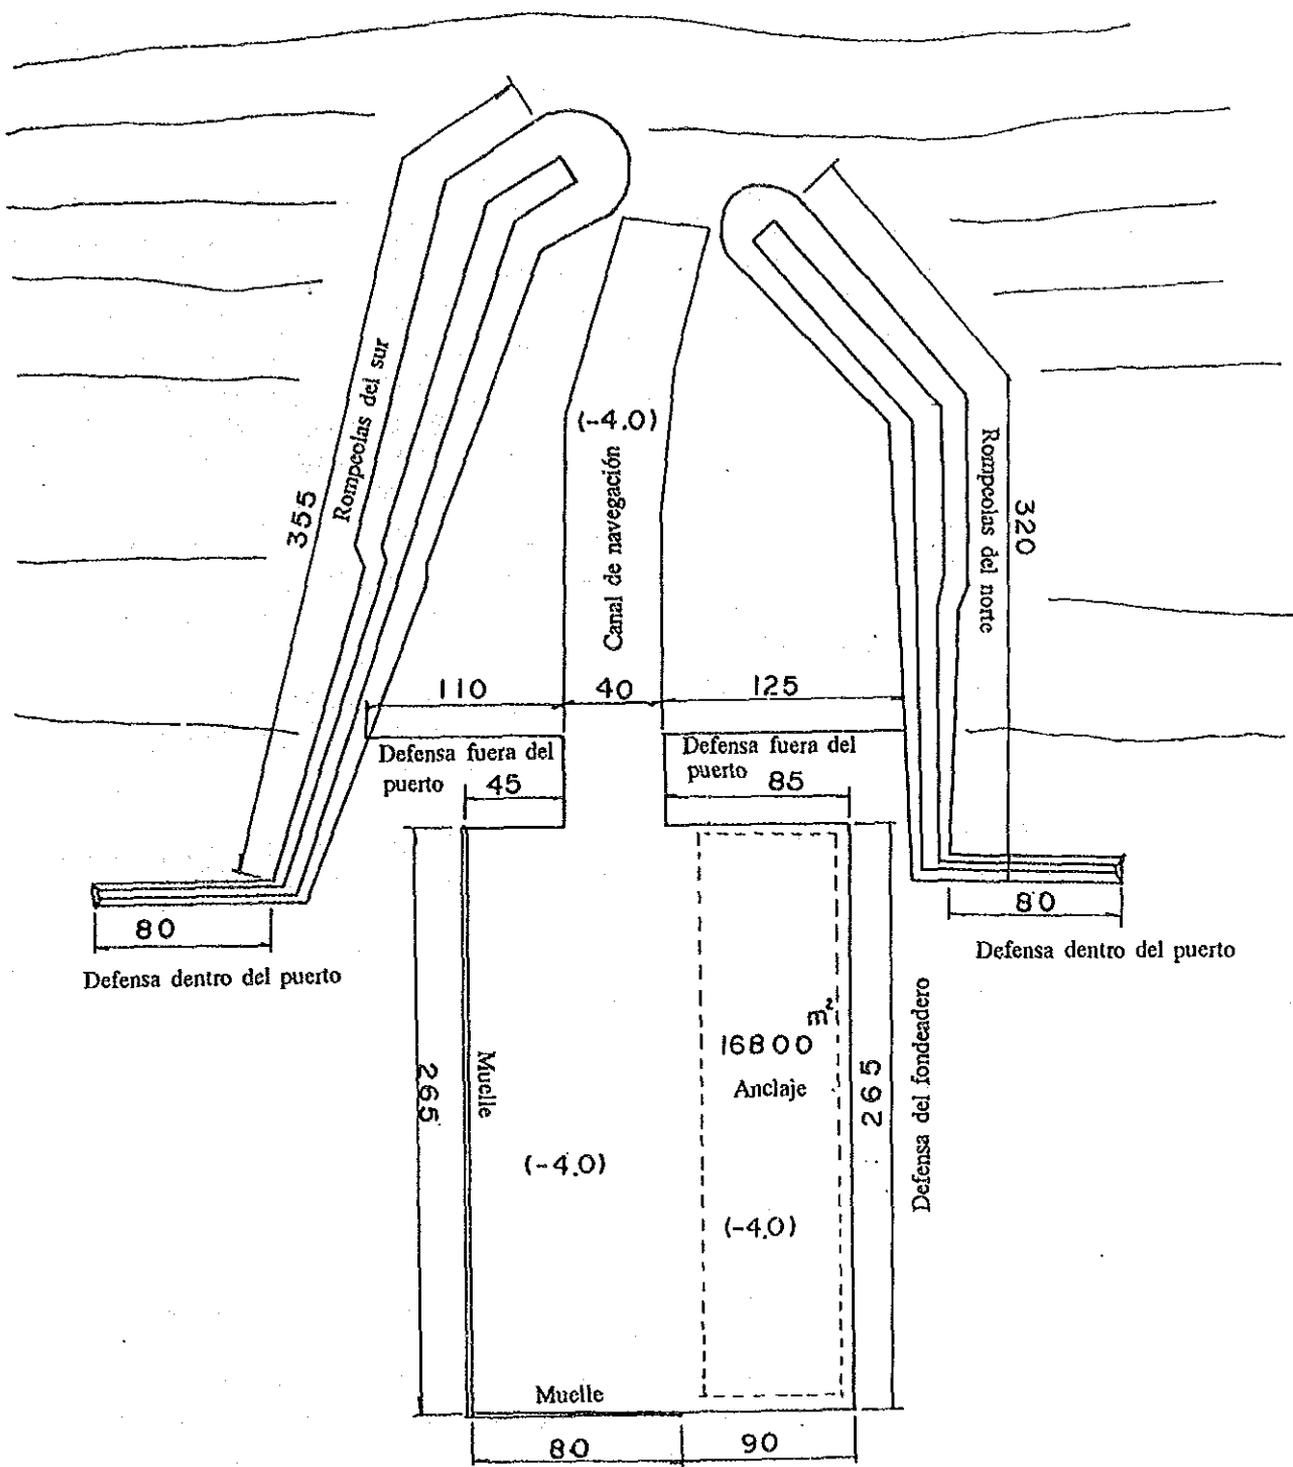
Plan de disposición del proyecto de desarrollo a corto plazo
